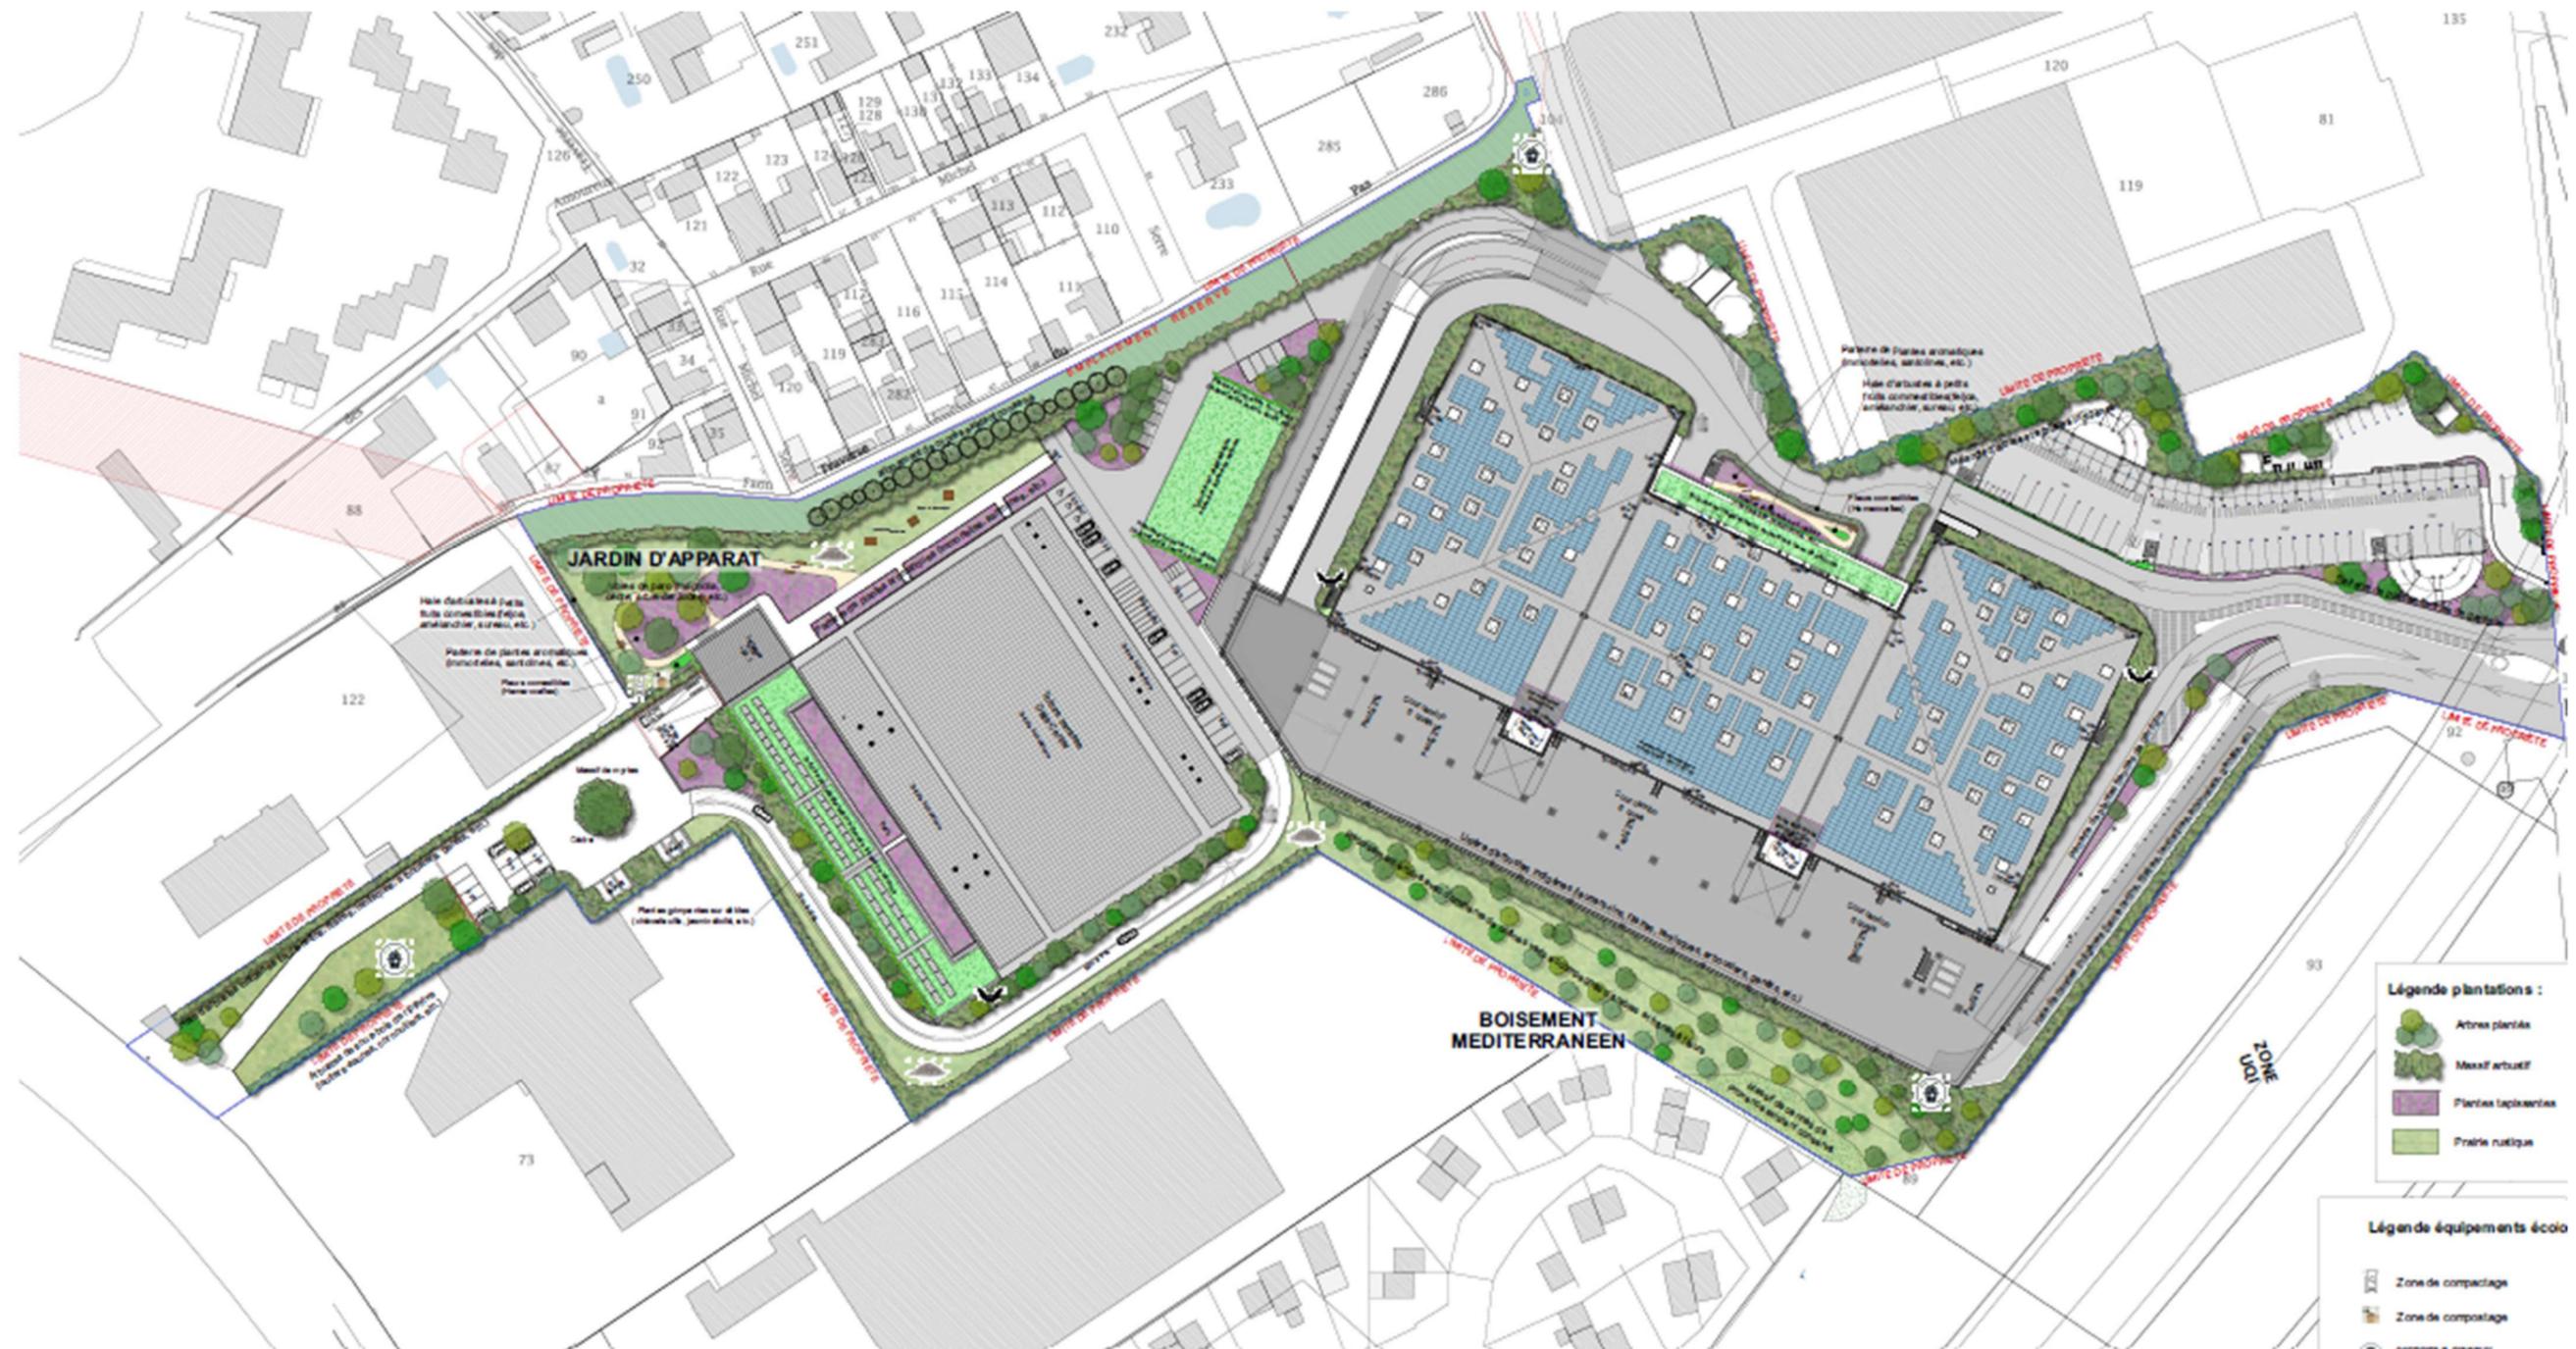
Plan du projet de construction immobilière (source : dossier PC – Atelier 4+) – Marseille (13)
